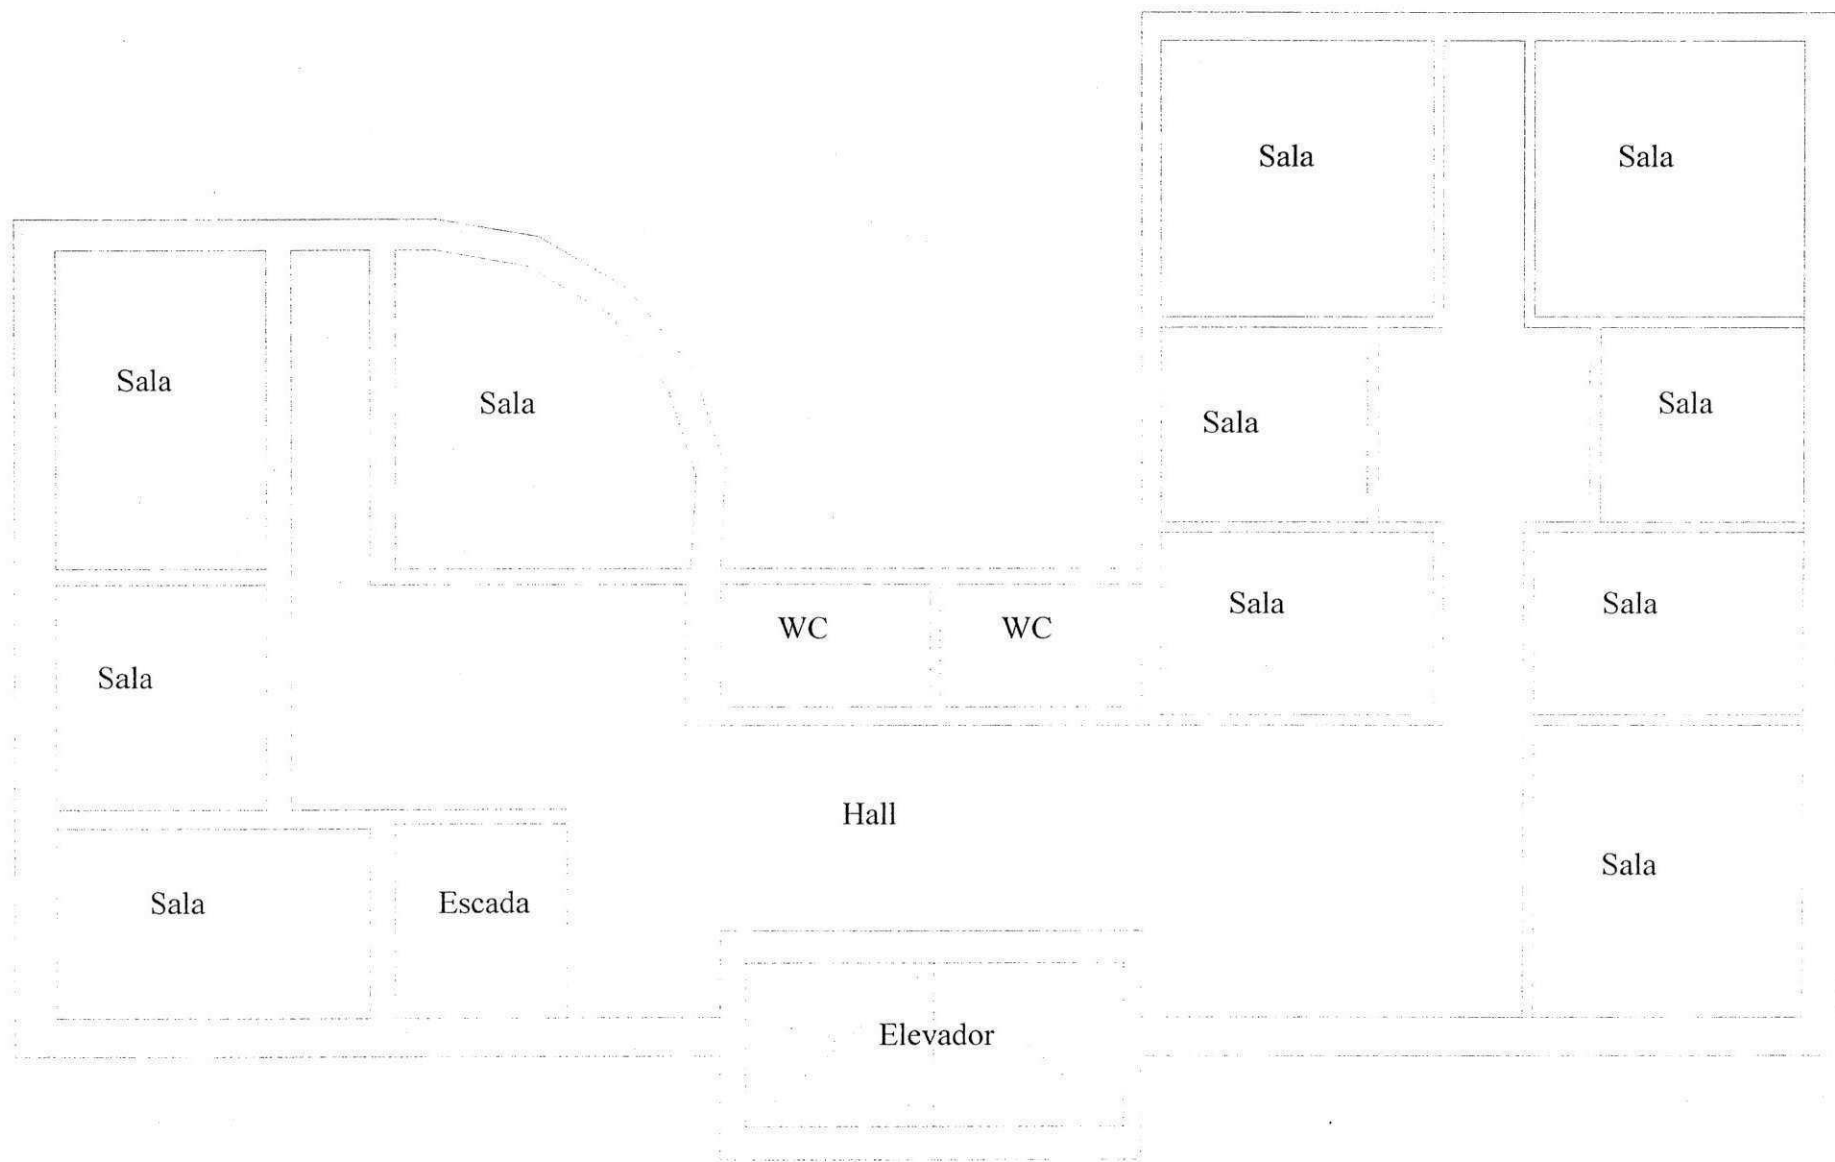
Esboço da Planta baixa do pavimento tipo do edifício
